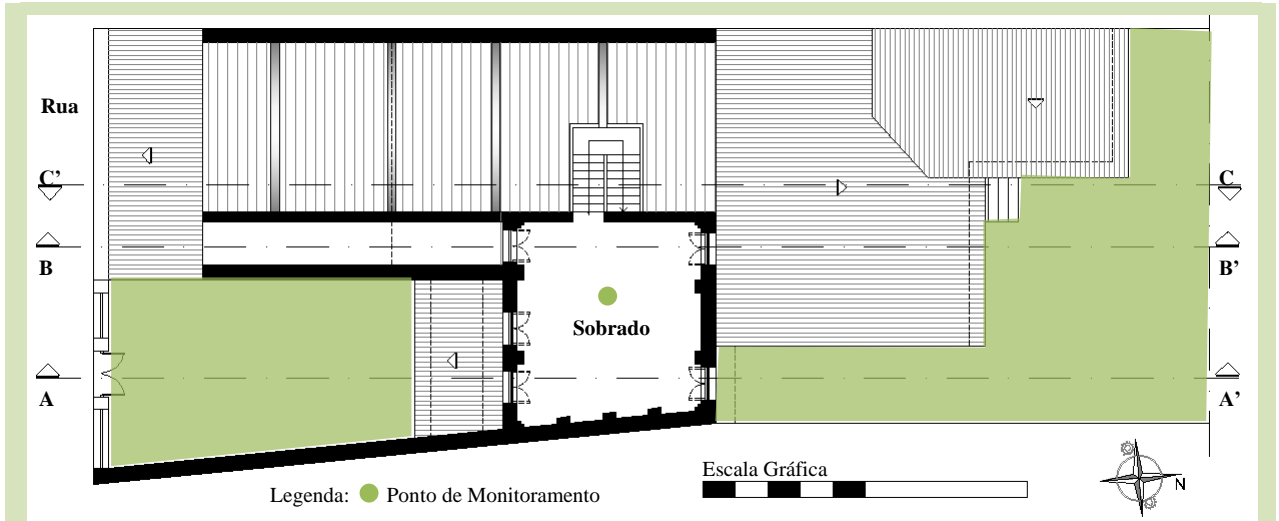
Planta Baixa do pavimento superior da Casa 4. Fonte: idem.
